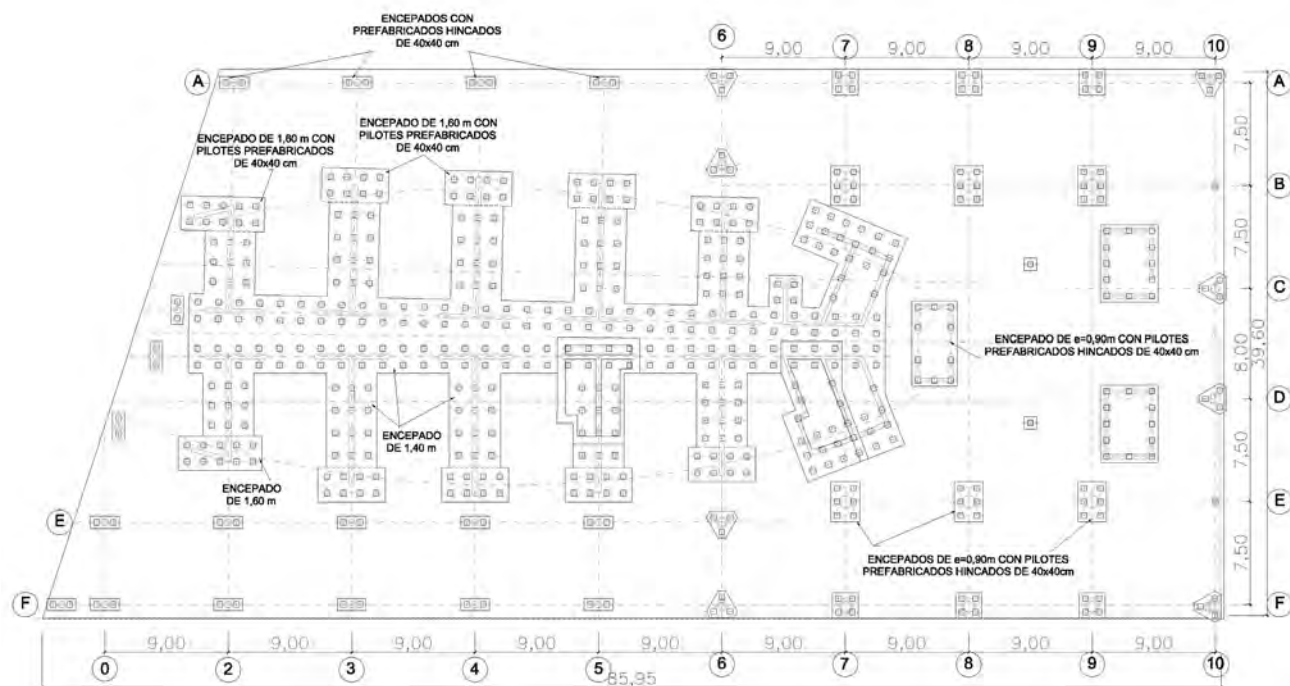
Planta de la cimentación de los edificios Torre y Atrio con pilotes prefabricados hincados.
